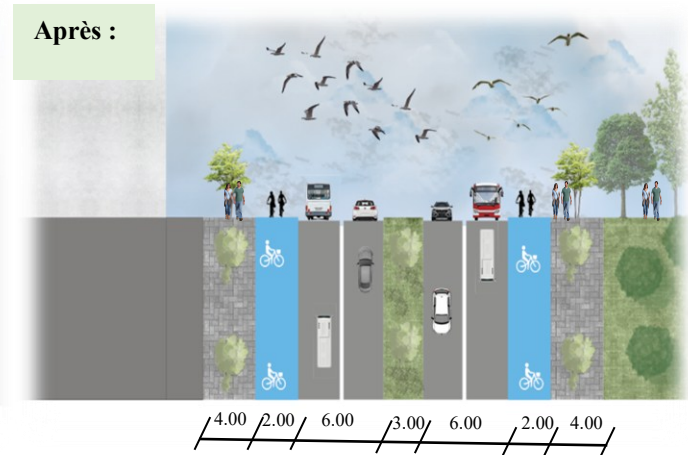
plan et coupe de l'avenue Chabane Ahcene après l'intervention.
